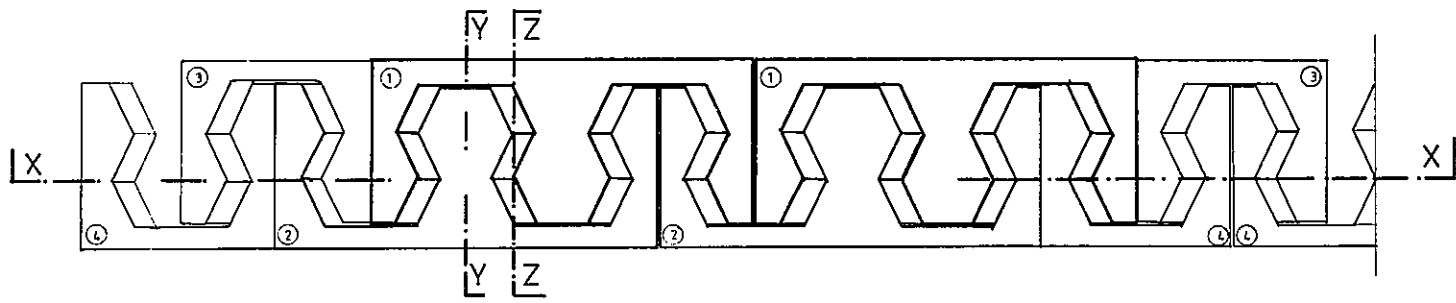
PLANTA DE MURO Y DISPOSICION DE HILADAS
